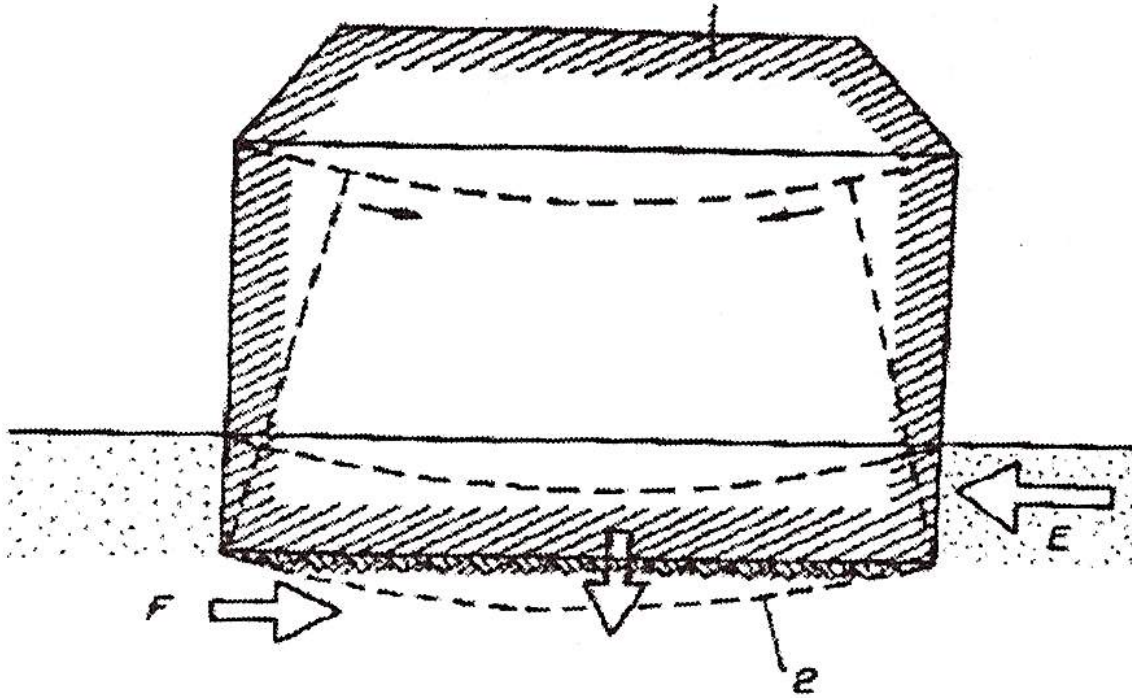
Esquema de protección total de una obra con baja rigidez, 1) construcción, 2) curvatura del terreno de superficie, E) presión lateral, F) fuerza de fricción.
